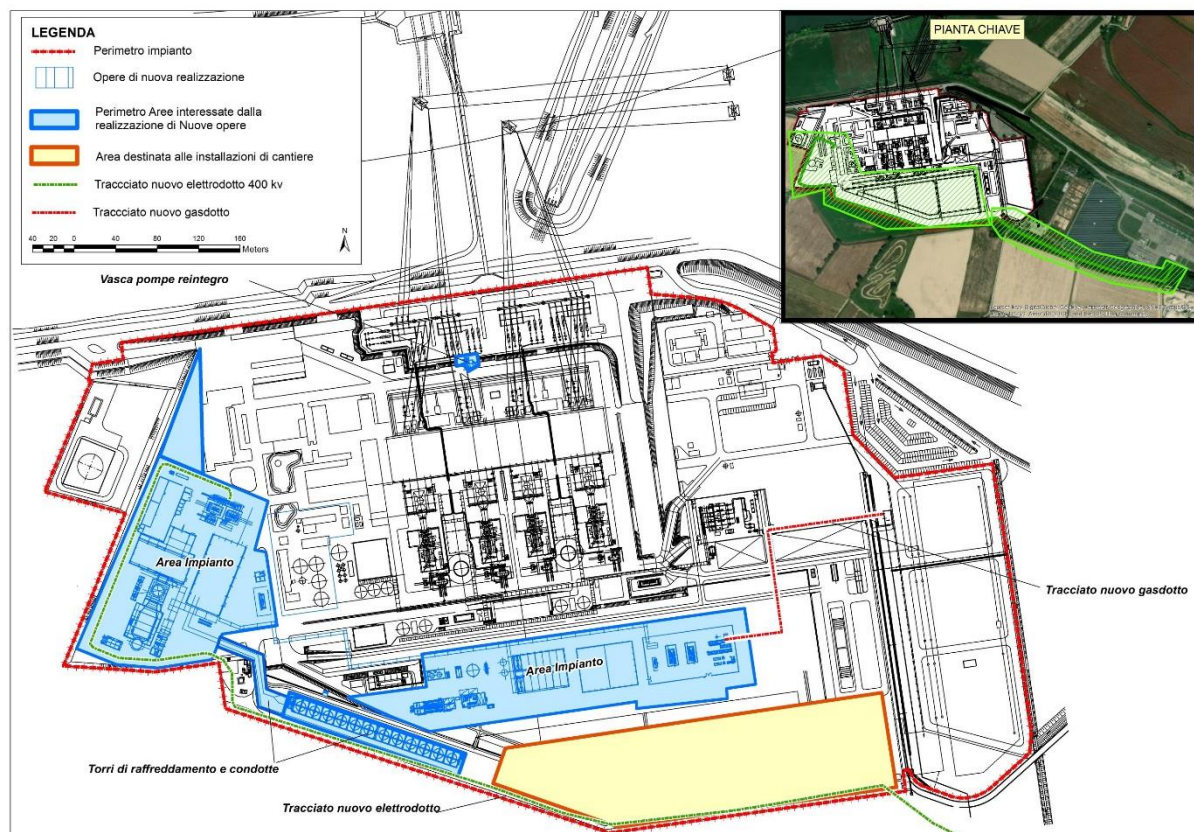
Layout di impianto con le aree interessate dalle nuove opere
